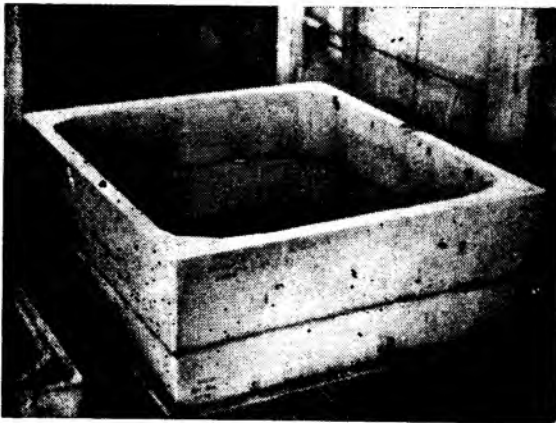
Блоки из напрягающего бетона после тепло-влажностной обработки
